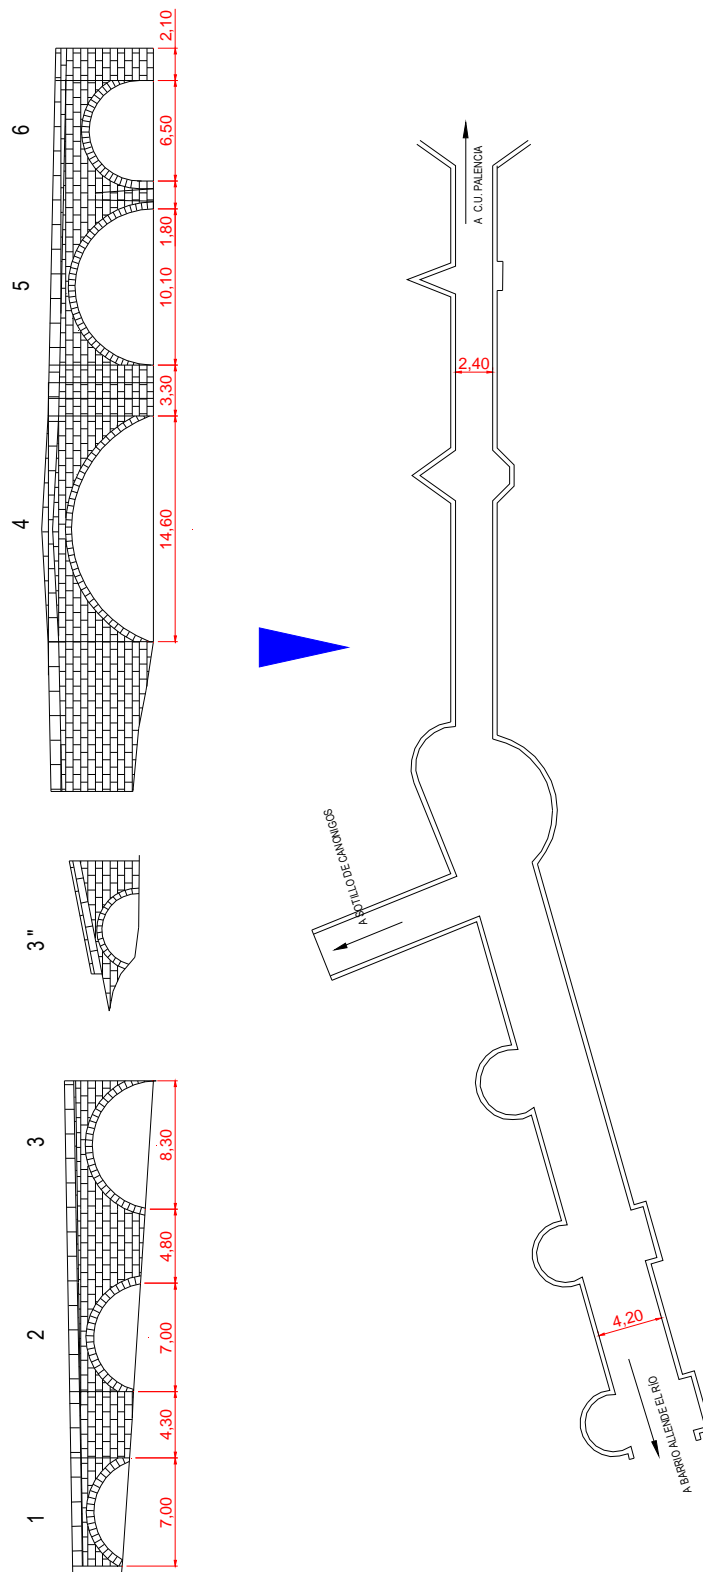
Planta y alzado de aguas abajo del puente de Puenteillas
